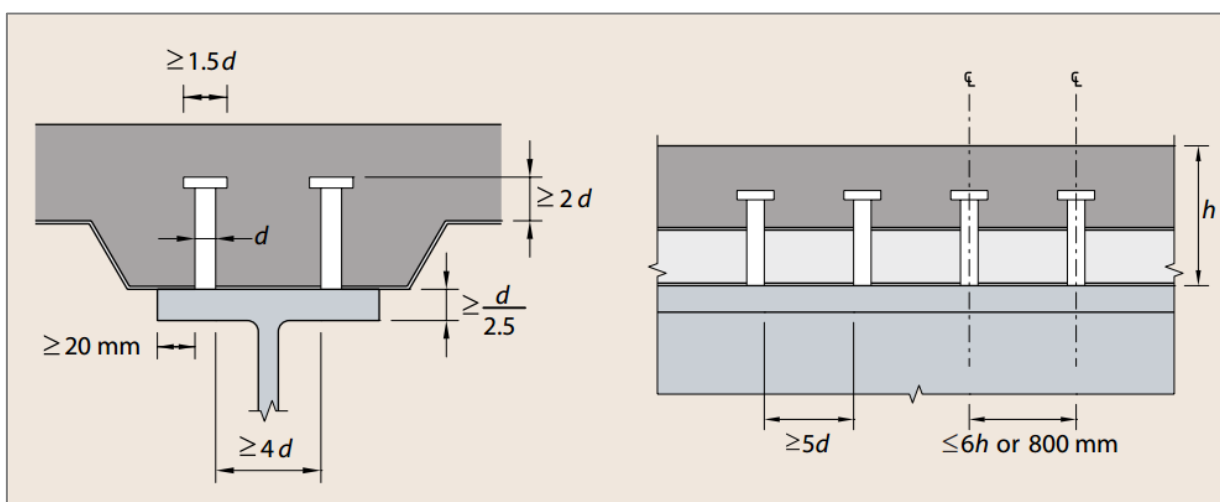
Algumas disposições construtivas para conectores tipo stud (Simms e Hughes, 2011).
